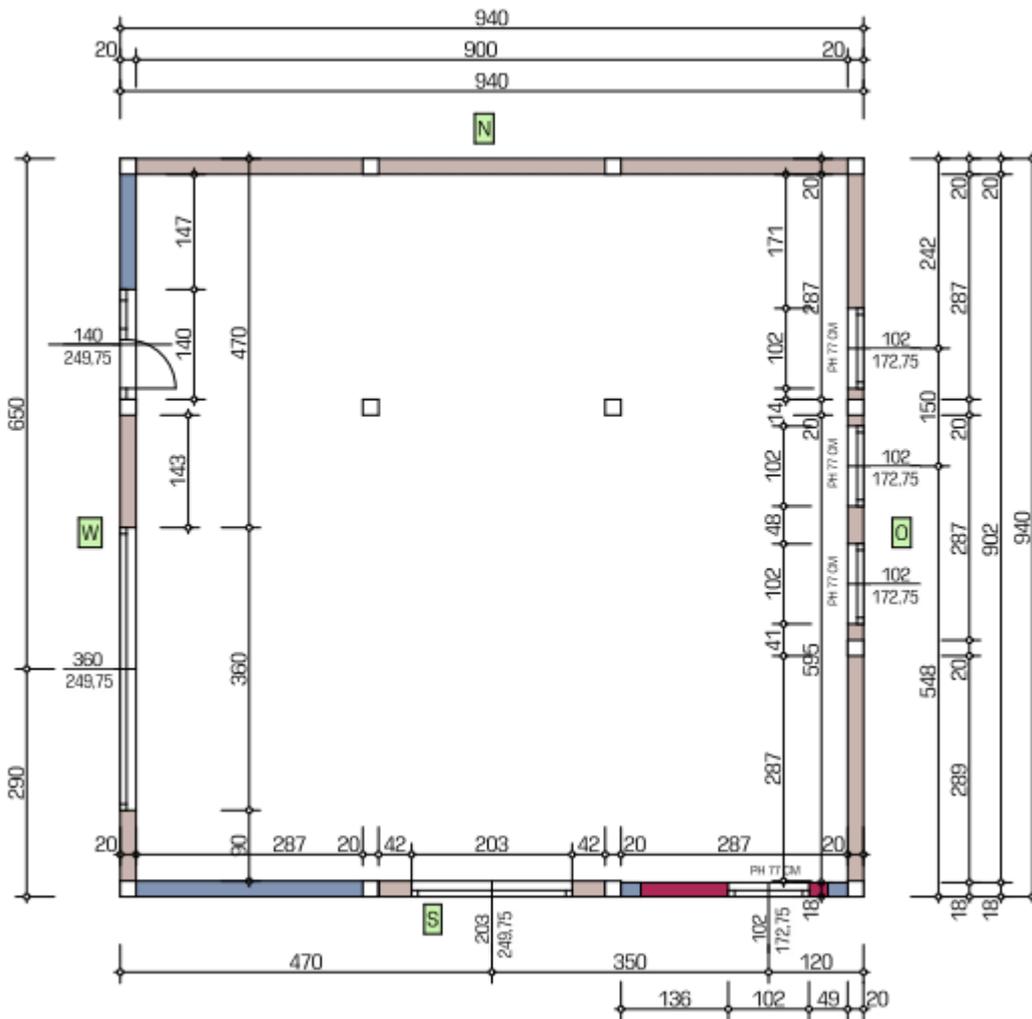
Grundriss des Mustergebäudes ohne Innenausbau
